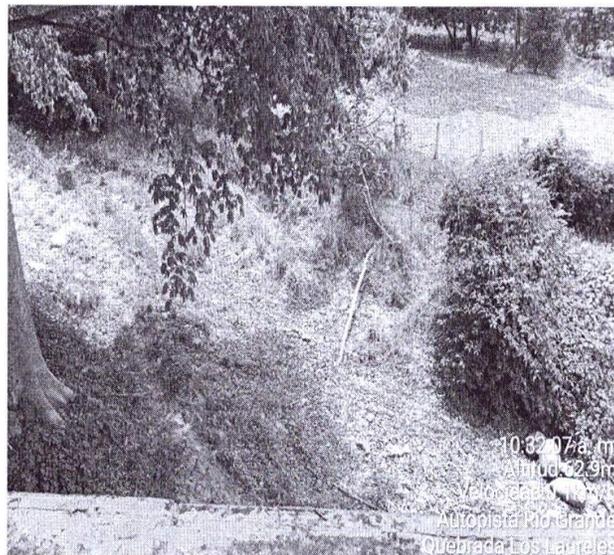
Vista general de la zona de captación propuesta sobre la Quebrada Los Laureles.
